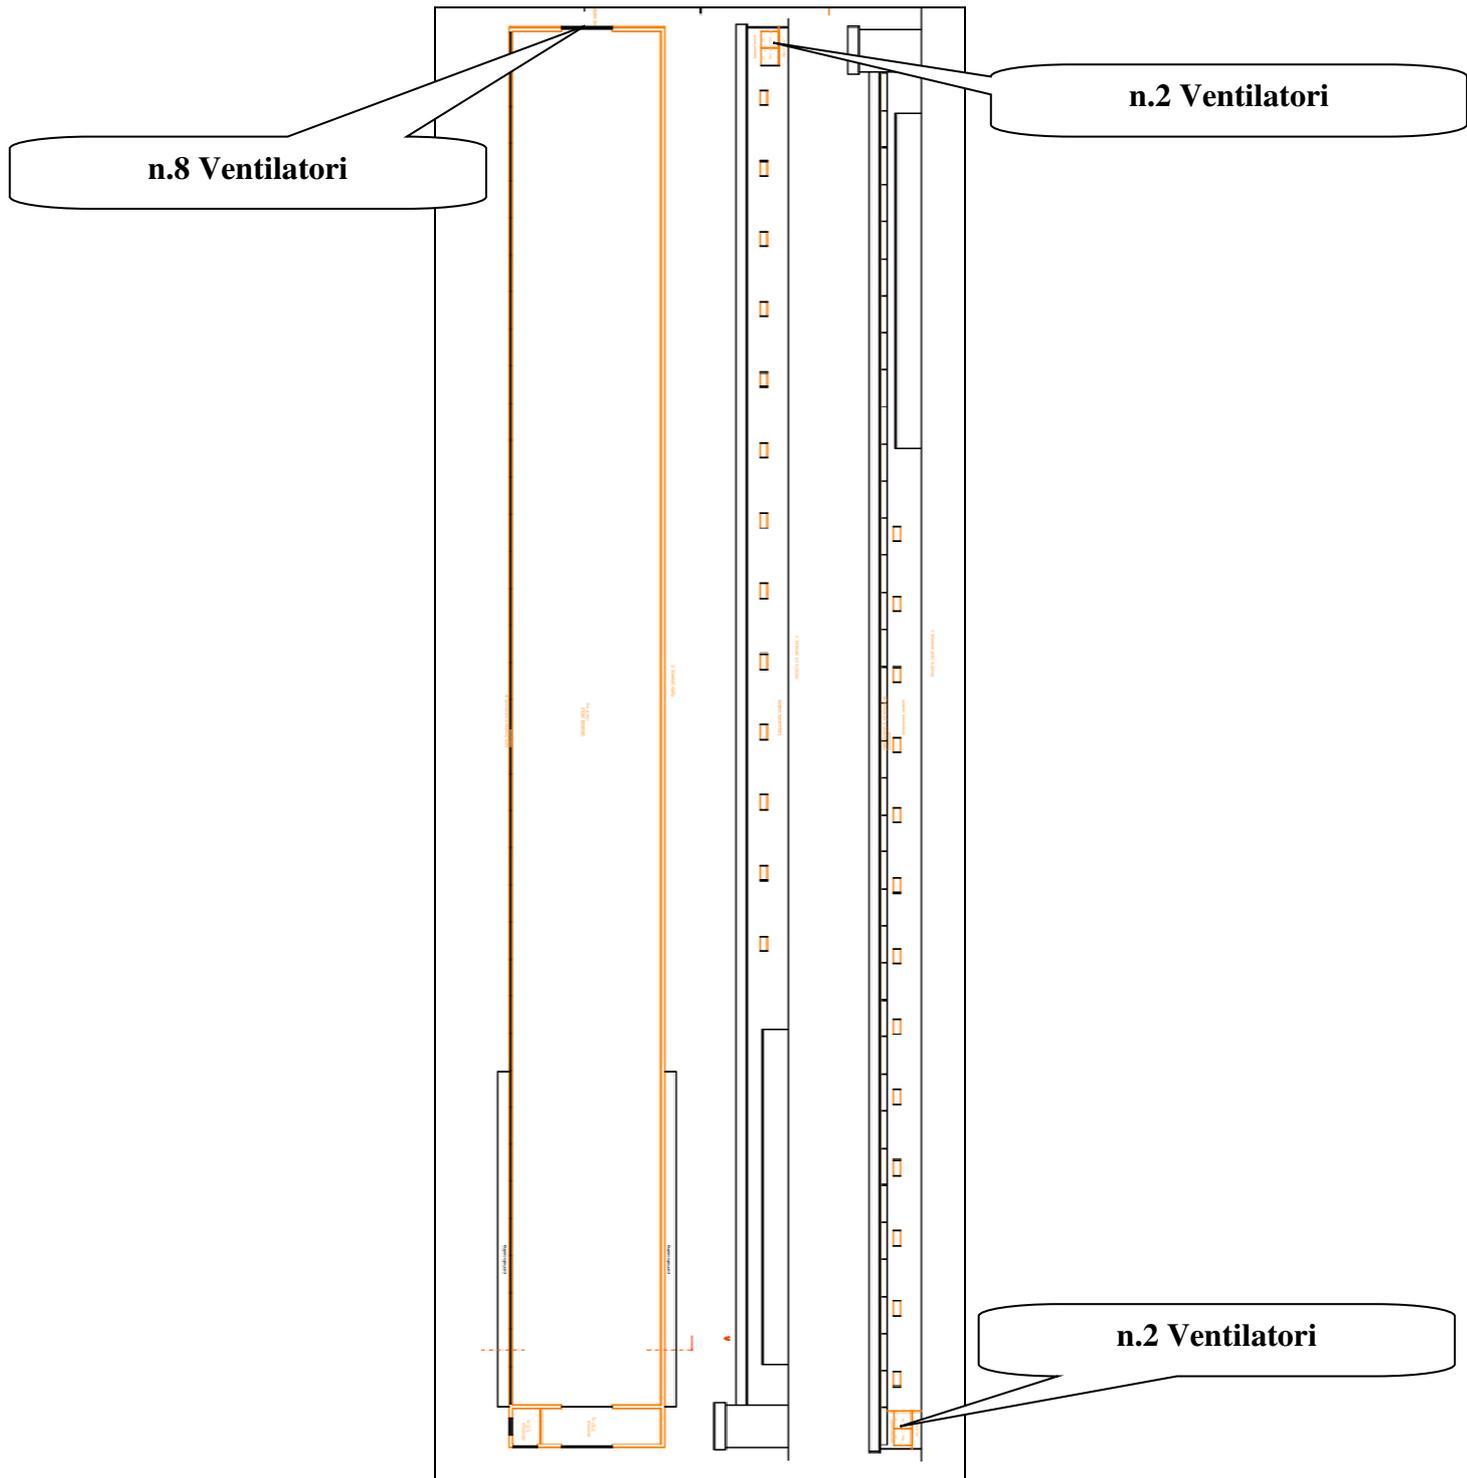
Pianta e prospetti CAPANNONE C stato futuro
